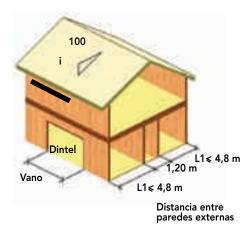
Dimensionamiento de dinteles de paredes exteriores de primer nivel en viviendas de dos pisos con entrepiso acústico.
